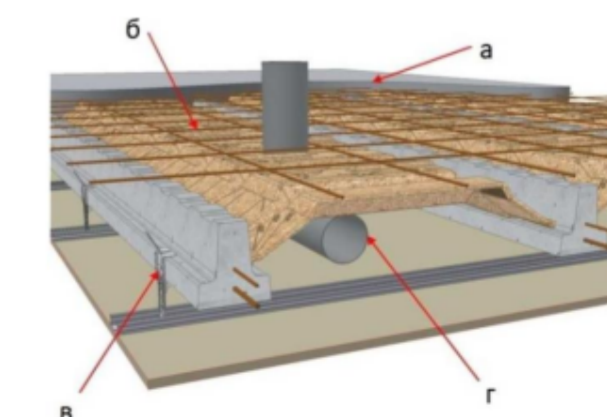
Форма перекриття Rectolight: а – монолітна стяжка; б – арматурна сітка; в – кріплення системи підвісної стелі; г – монтажний елемент
